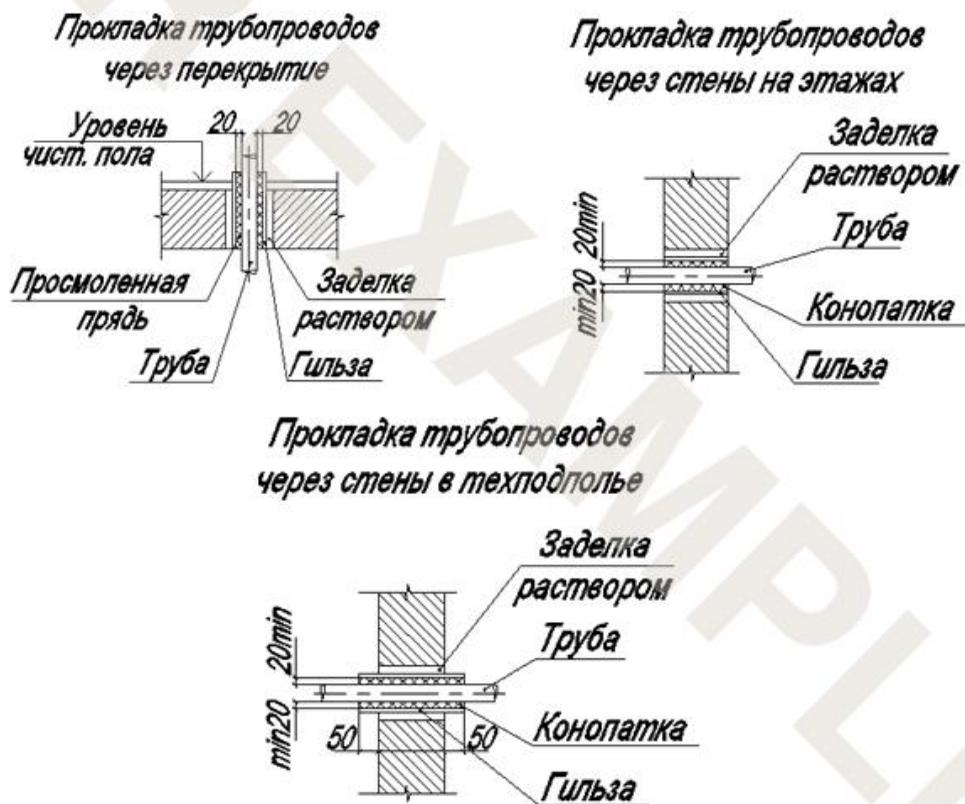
Установка гильзы для прокладки труб в стенах и перекрытиях
